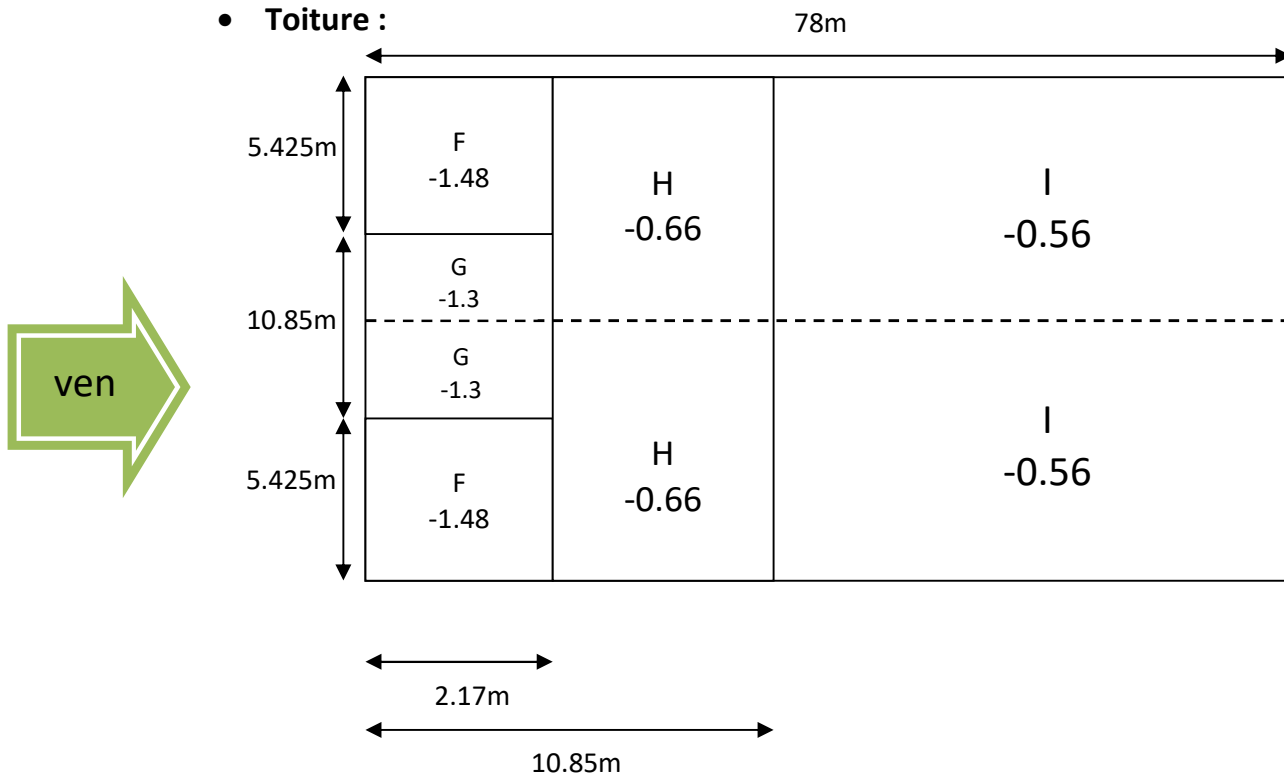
Cpe pour toiture (Vent sur pignon).
